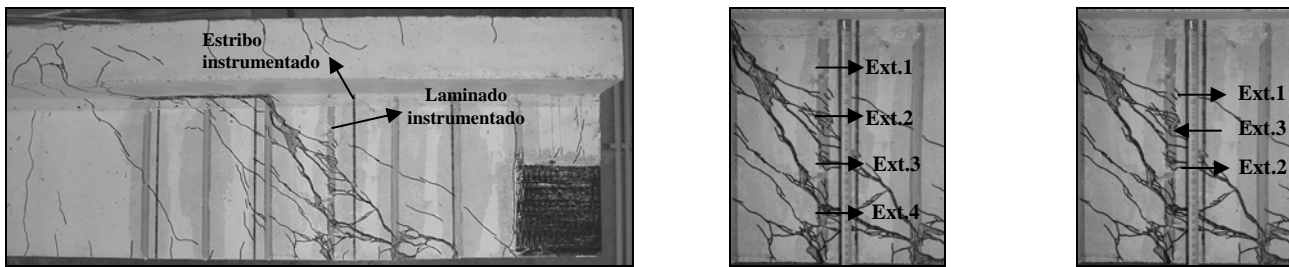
Localização dos extensómetros no laminado e estribo instrumentados da viga 4S-7LV-B.
